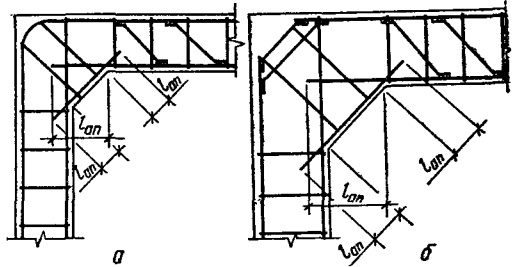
Армирование крайних верхних узлов рам сварными сетками при сжатых гранях входящего угла.
